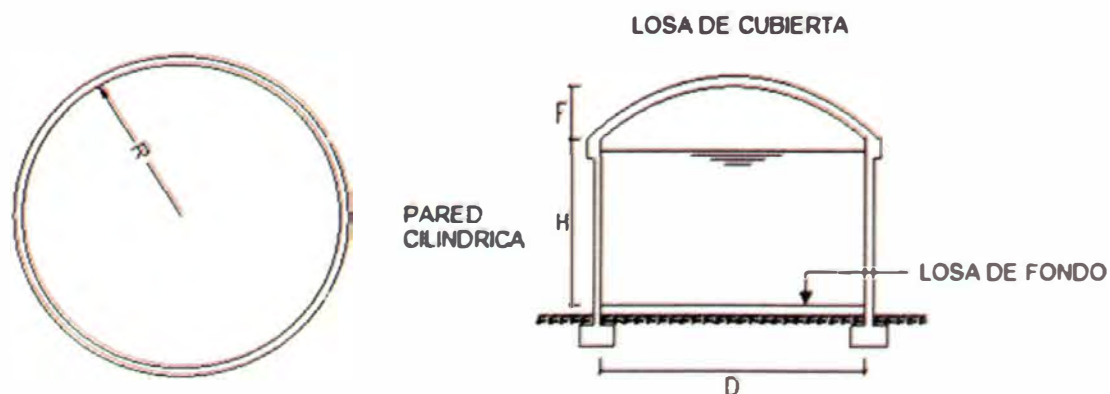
Esquema del reservorio en planta y elevación.
